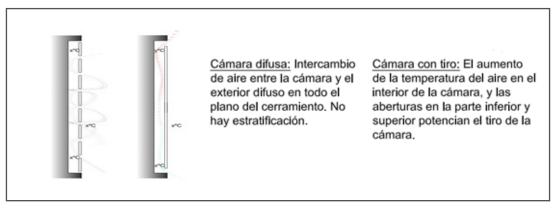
Formas de ventilar las cámaras Fuente: elaboración propia
